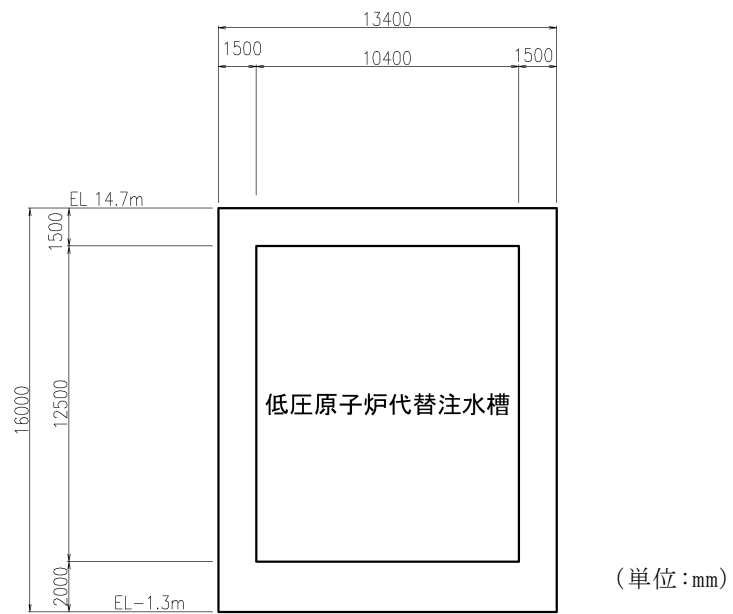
低圧原子炉代替注水ポンプ格納槽 断面図 (B-B 断面)
